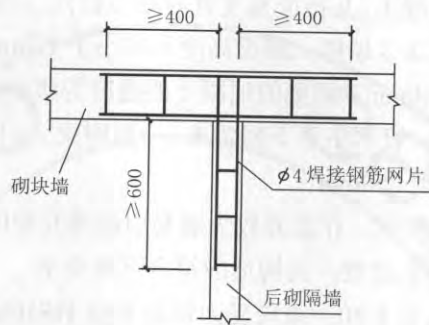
砌块墙与后砌隔墙交接处钢筋网片
